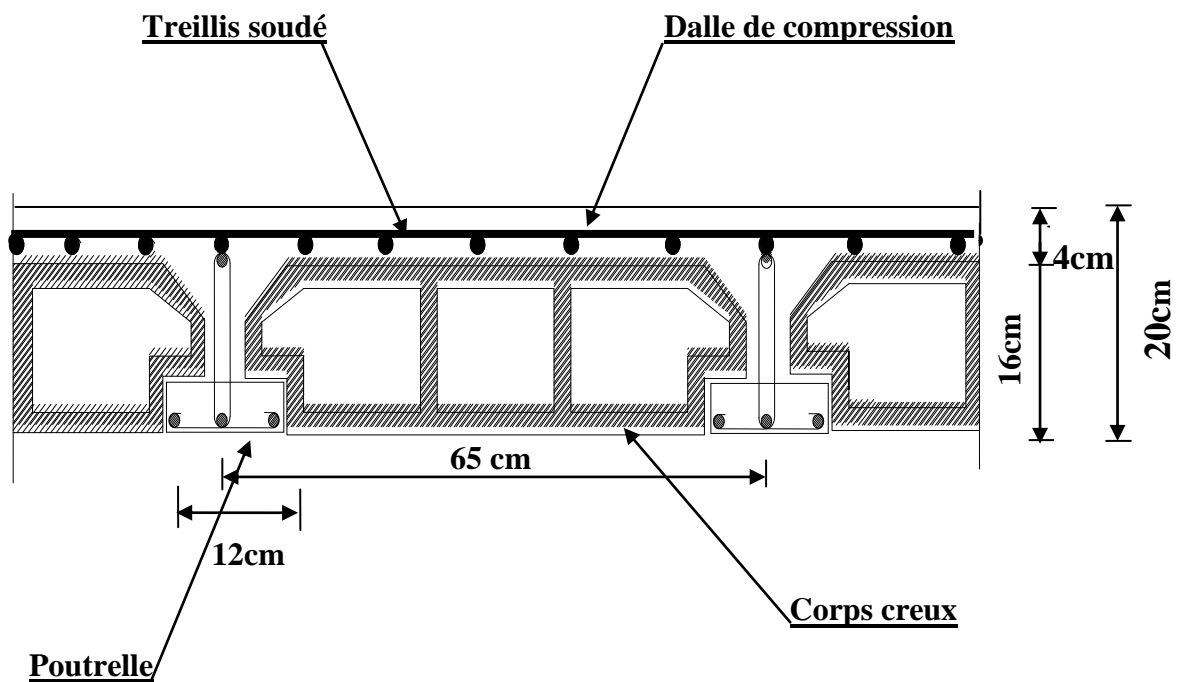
Coupe transversale d'un plancher en corps creux.
